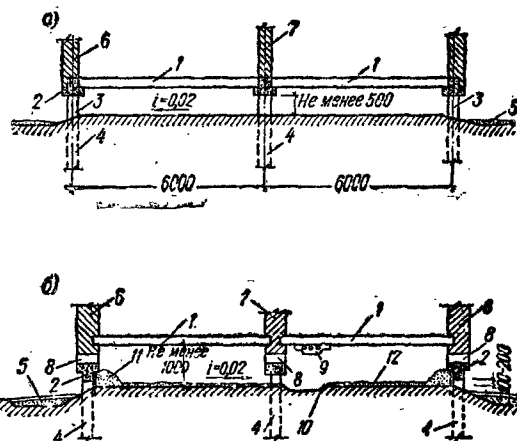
Схемы холодных (проветриваемых) подполья в зданиях, возводимых на вечномерзлых грунтах
